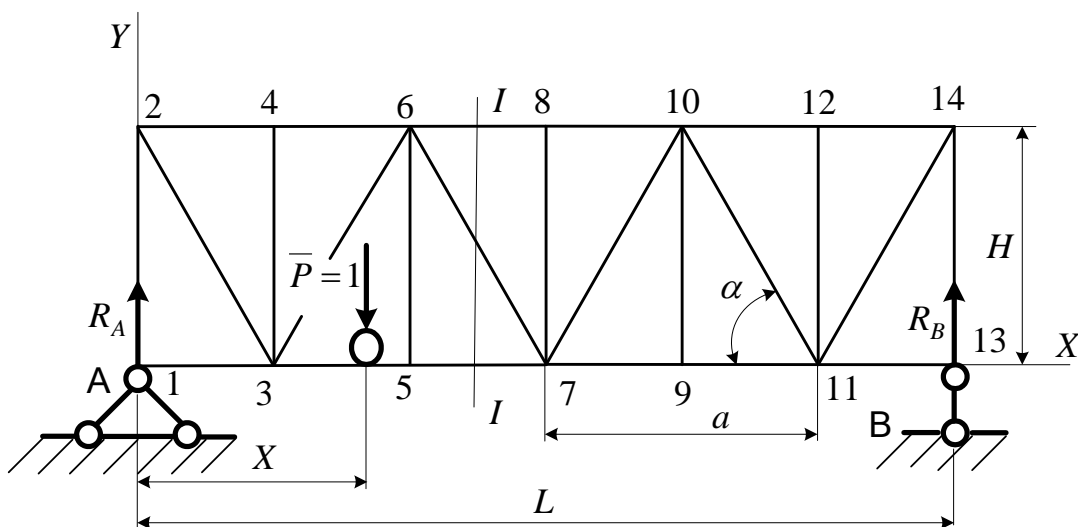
Схема фермы с подвижной нагрузкой по нижнему поясу
